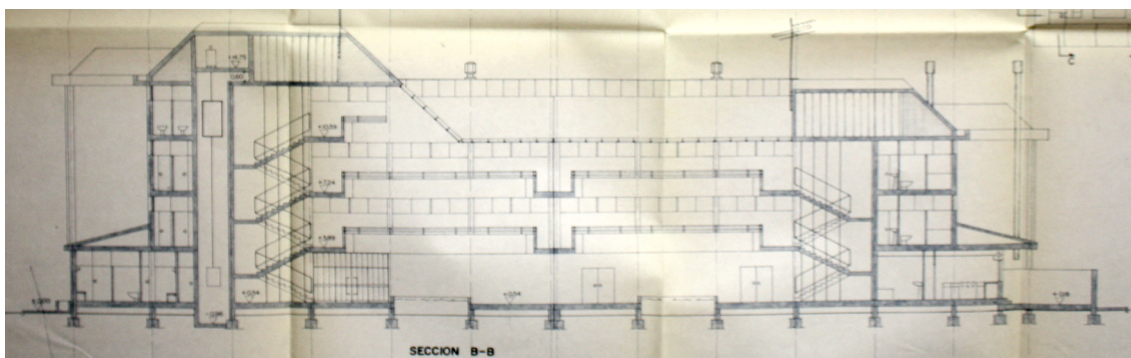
Sección tipología “atrio” proyecto tipo 24 unidades.
